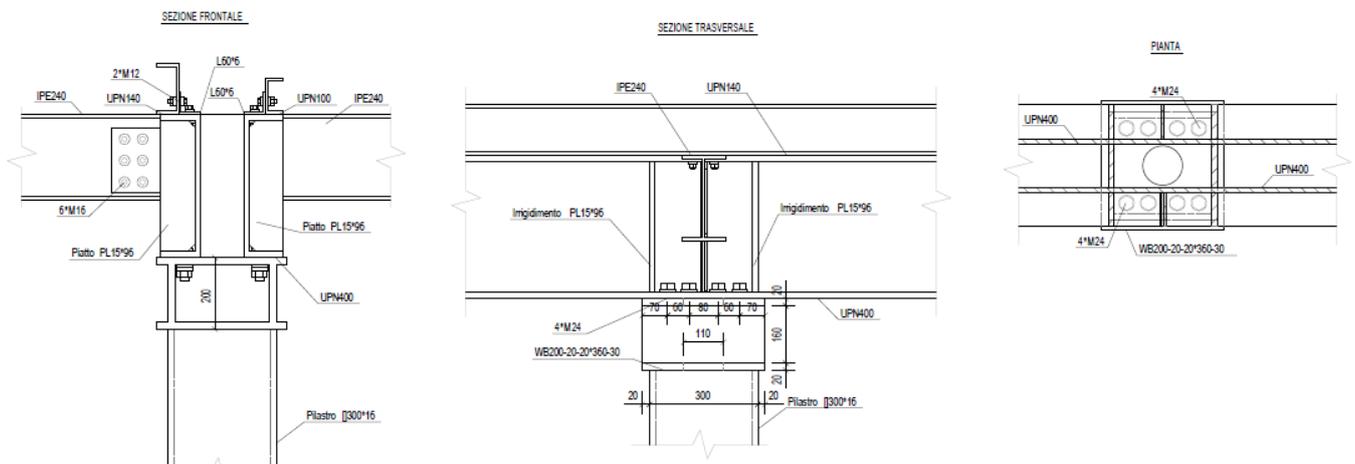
Pensiline – Dettaglio nodo di collegamento trave-colonna
